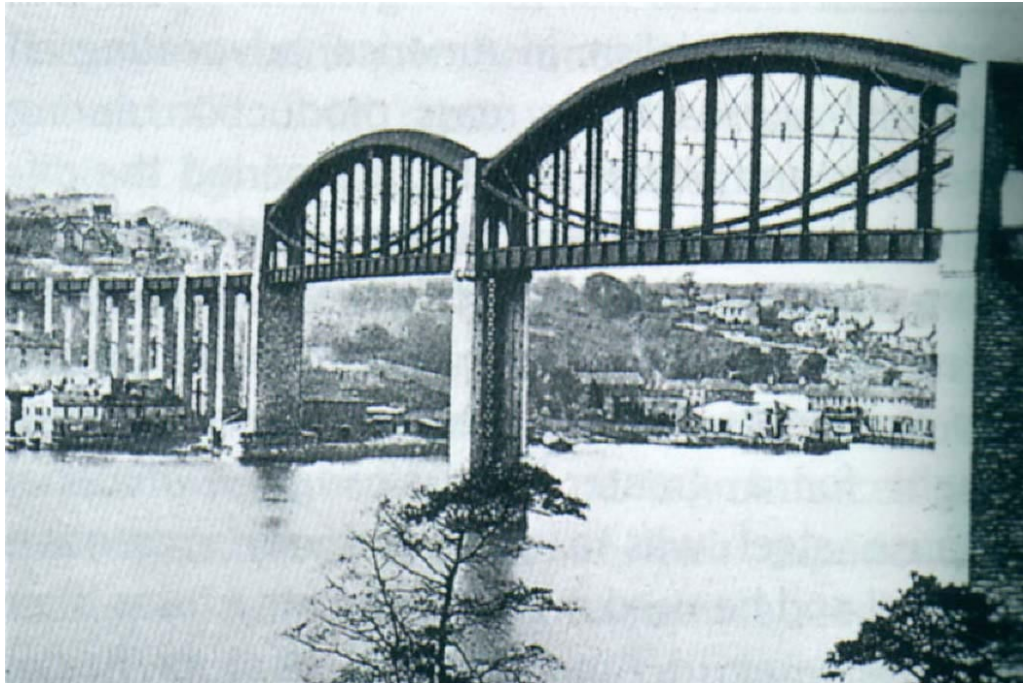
Ponte Royal Albert ou Saltash Railway Bridge – Plymouth, Inglaterra
